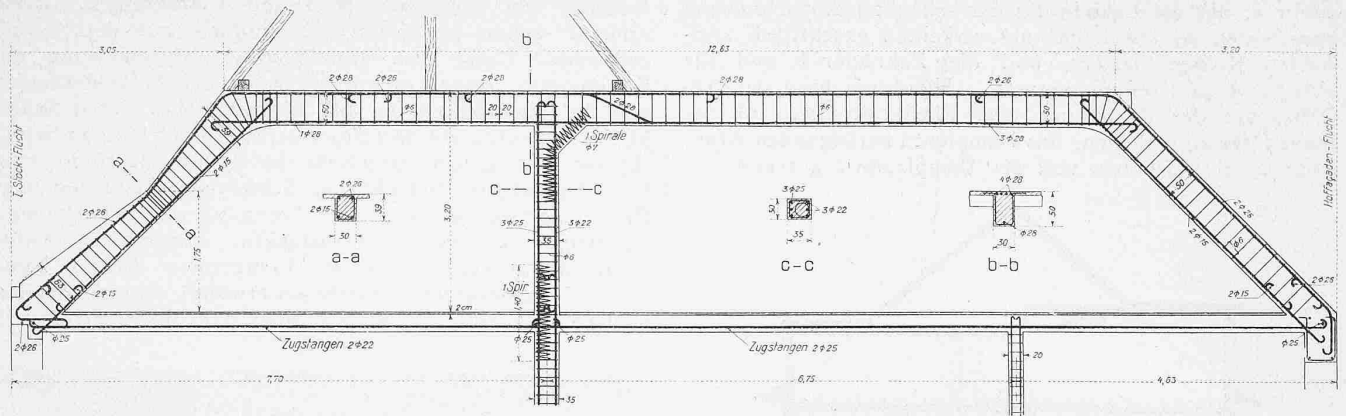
Armierungsplan des Dachbinders G. — Masstab 1:100.
